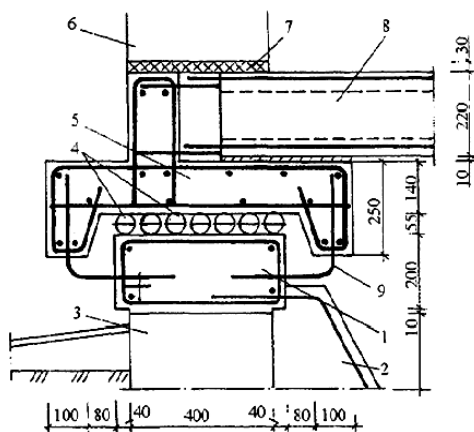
Железобетонный механизм сейсмоизоляции на сфероидах: 1 — железобетонный пояс фундамента; 2 — контрфорс; 3 — фундамент; 4 — цементно-песчаный сфероид; 5 — железобетонный пояс стены; 6 — стена; 7 — упругая прокладка; 8 — перекрытие над подвалом; 9 — условная тормозная связь
